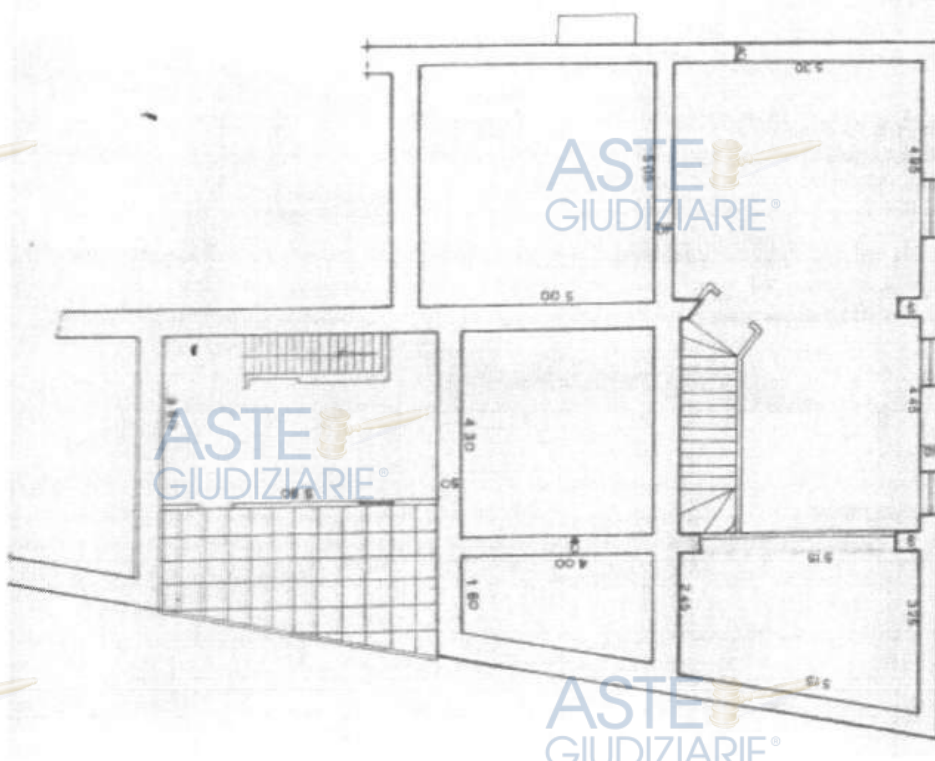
Pianta Piano 2° (sottotetto) allegata alla "Concessione per l'Esecuzione di Opere Edilizie n. 571/1998 prot. n.13666 del 27.10.1998
